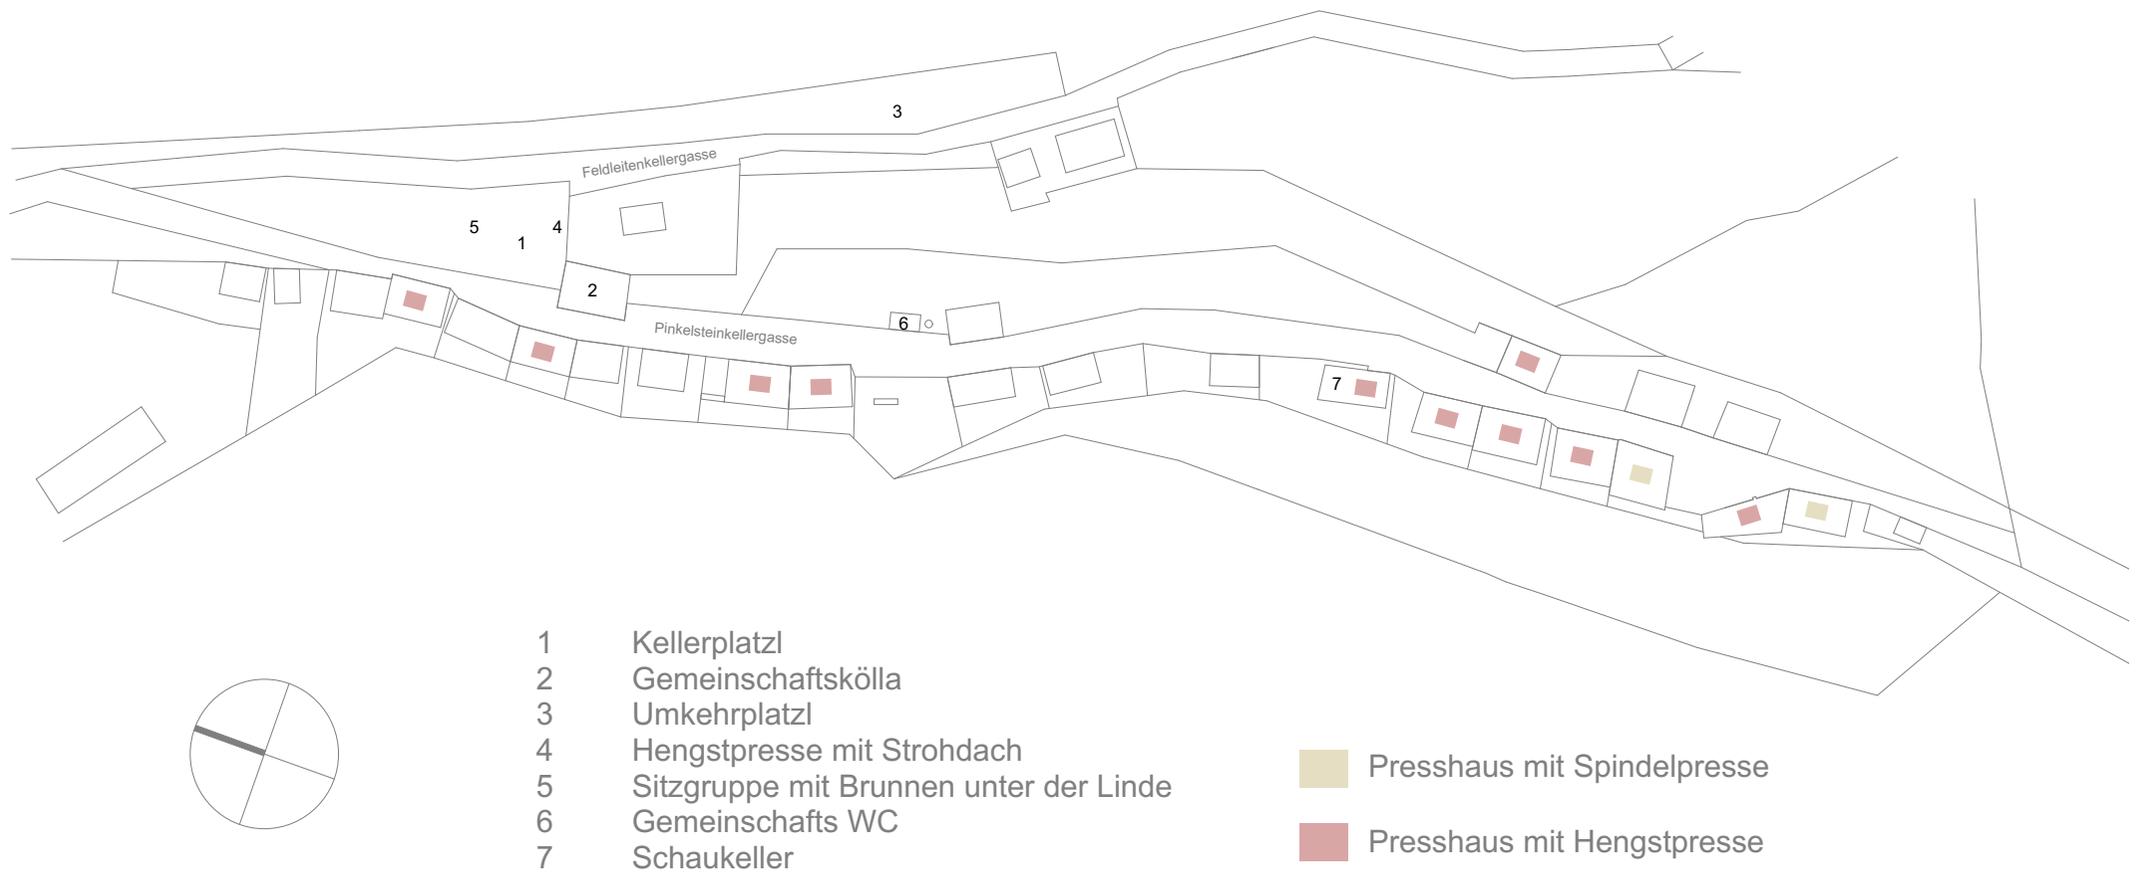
Bestandsaufnahme Lageplan Maßstab 1:1000
